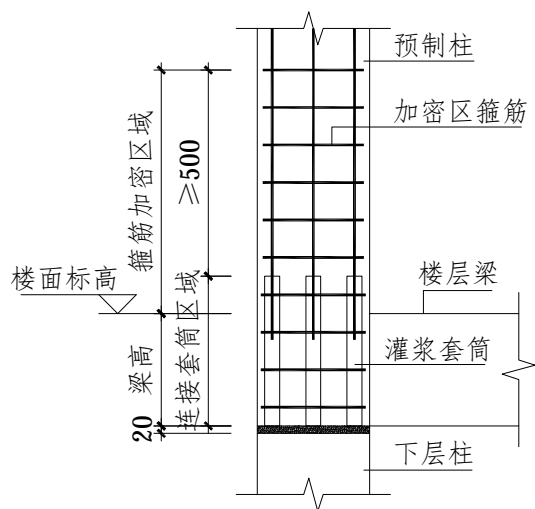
一层预制套筒灌浆连接预制柱柱底箍筋加密构造
